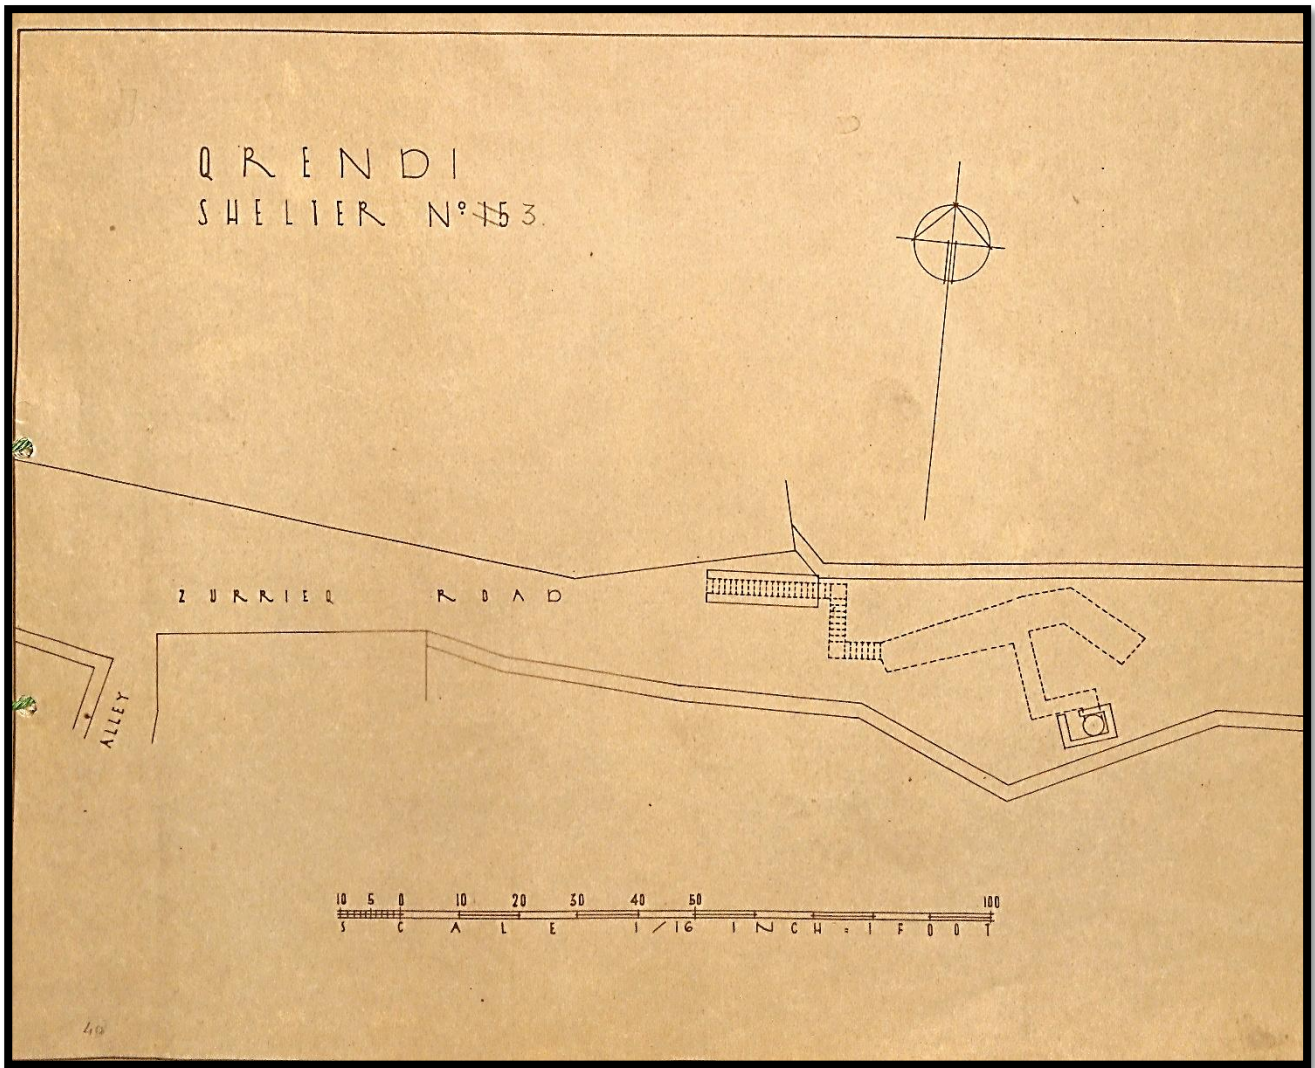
Planta do Abrigo nº3 "Alley – Zurrig Road"
